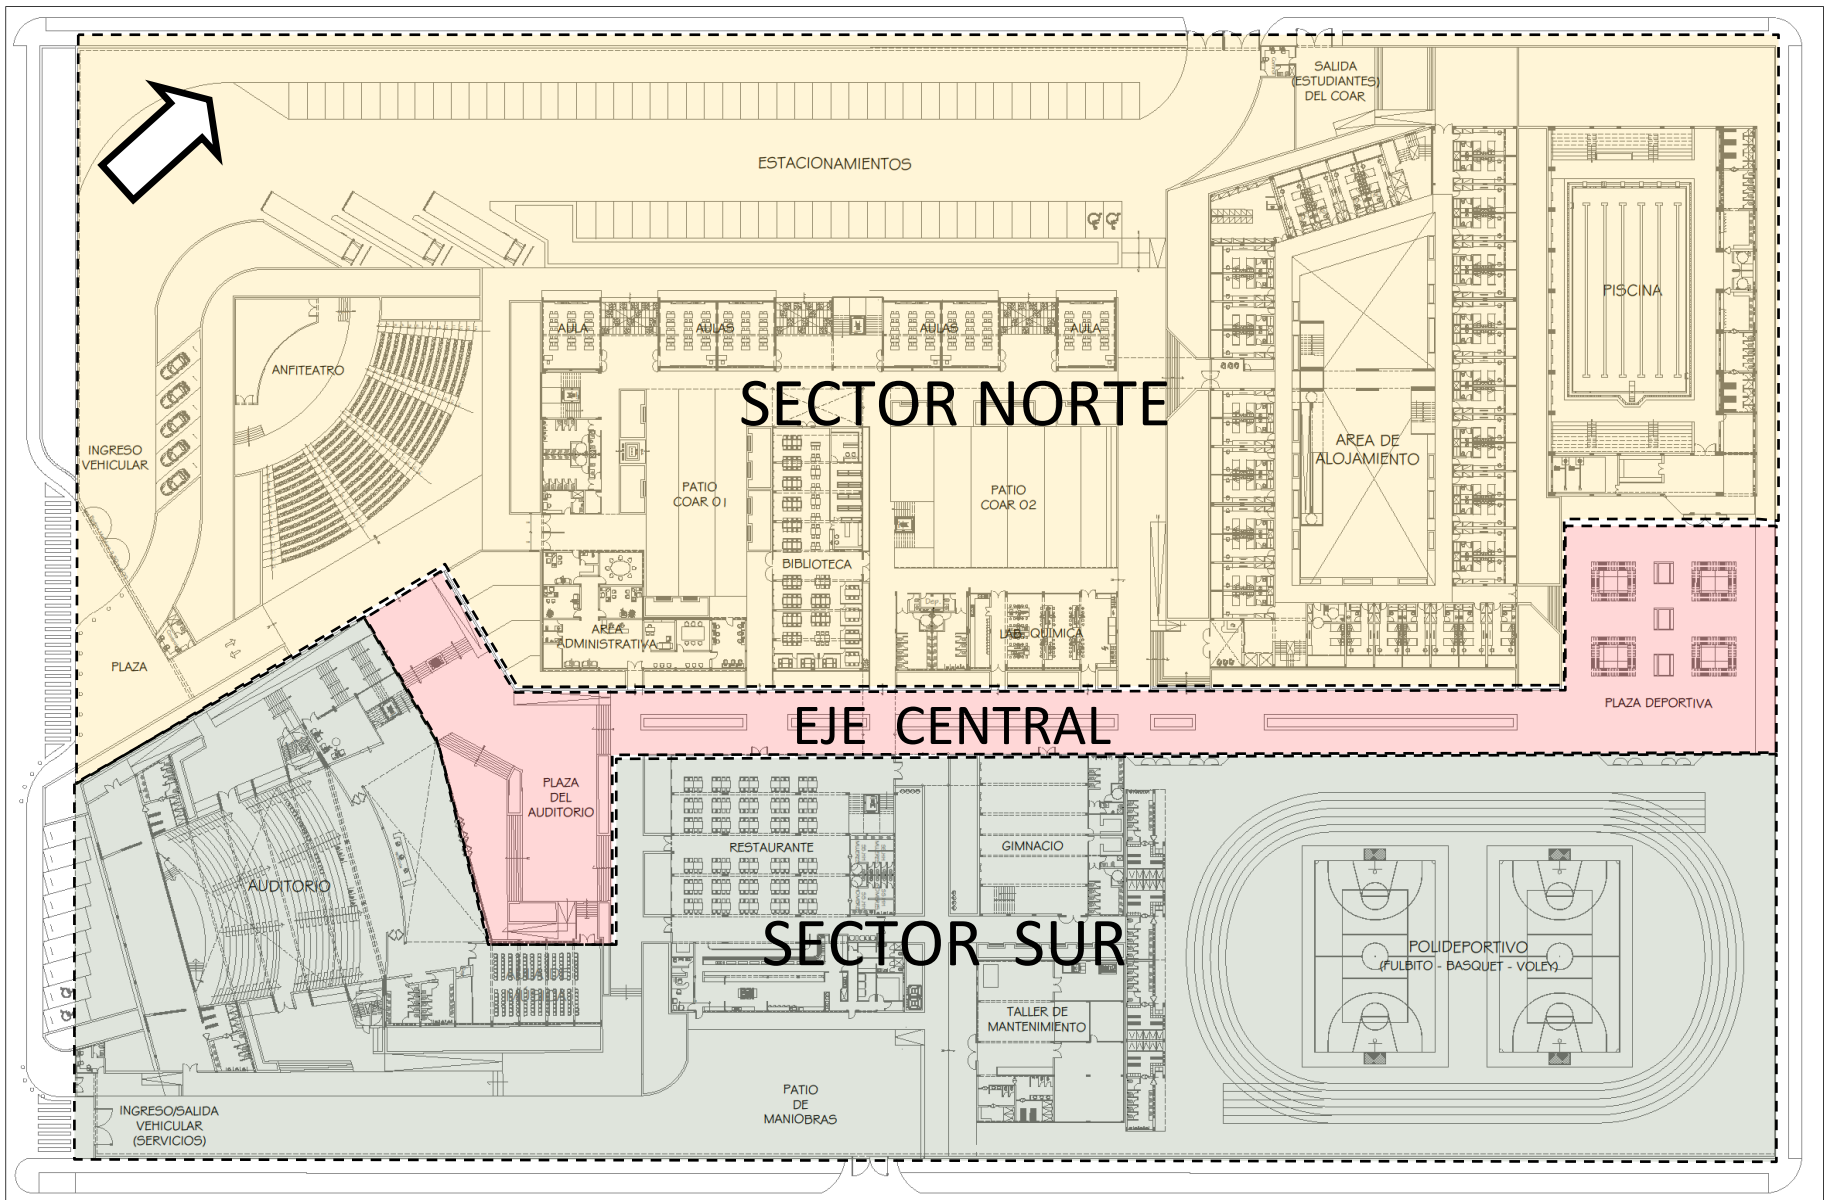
Plano General del Primer Piso del Proyecto de Investigación - dividido en 3 Sectores.
